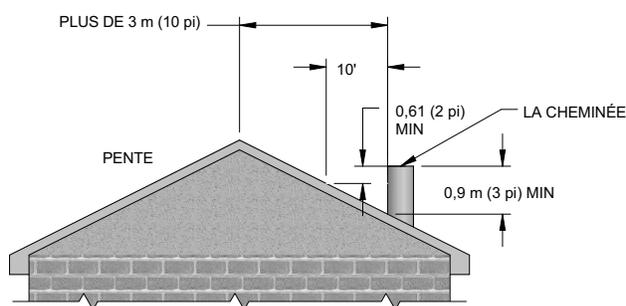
3_ Terminaison de ventilation à plus de 3 m (10 pi) de la crête d'un toit à double pente
